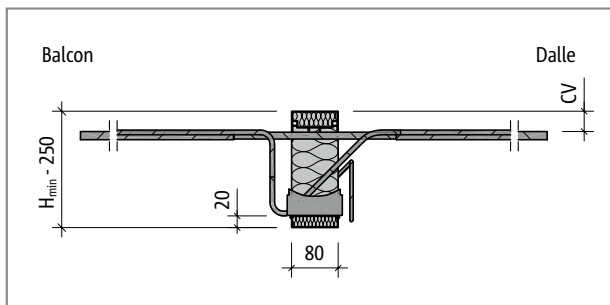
Schöck Isokorb® T Type K-E-M8 : Coupe du produit
